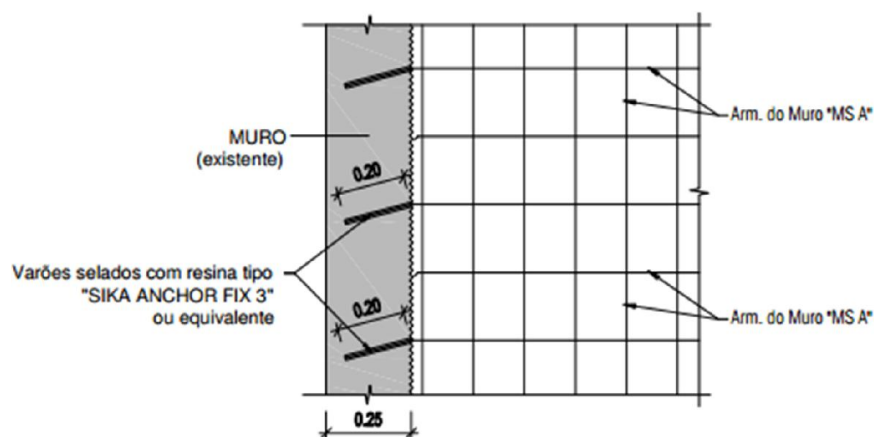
Pormenor da selagem do muro ao muro já existente (Marques, 2011).
